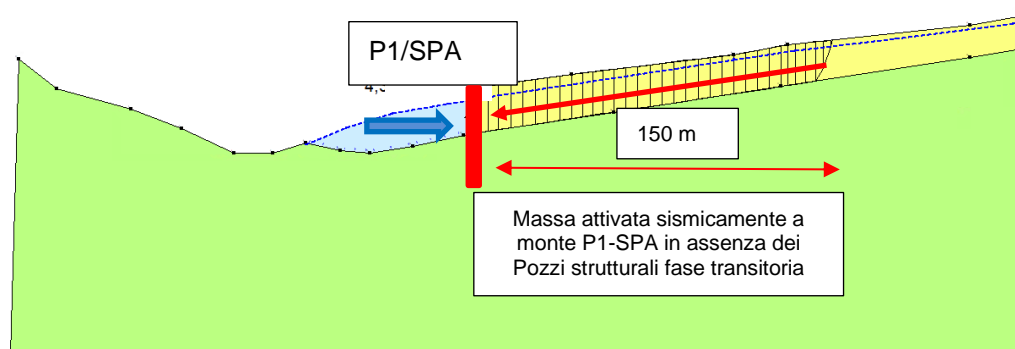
Schema concettuale determinazione delle spinte di frana sulla Pila/Spalla 1 in condizioni sismiche – Breve Termine
